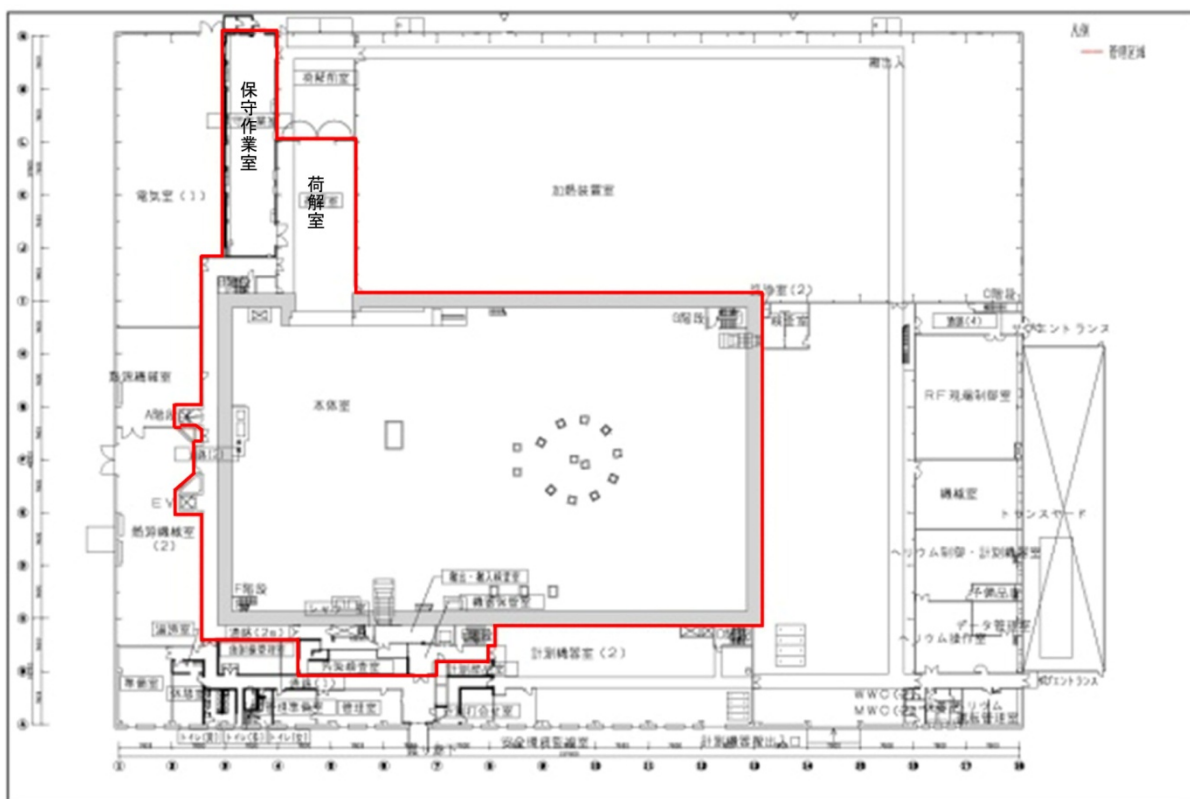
4-1 大型ヘリカル実験棟 1 階平面図
